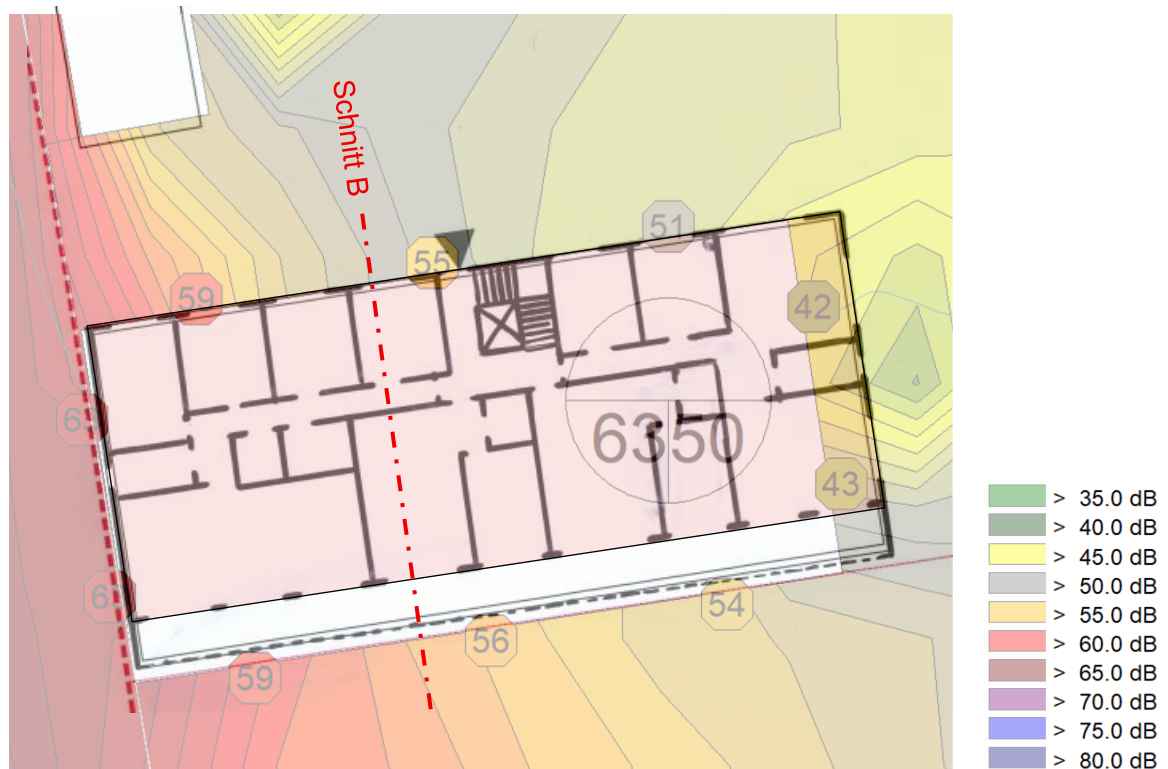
Grundrissoption Gebäude B mit Südausrichtung und reiner Wohnnutzung, EG-2.OG
